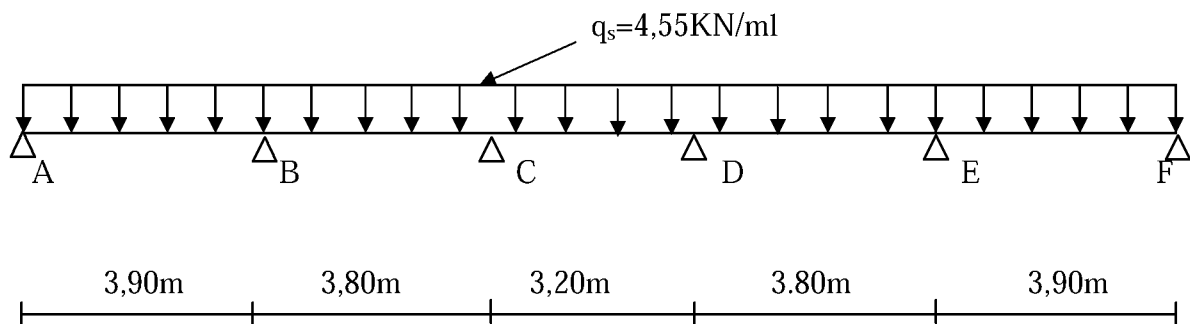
Schéma statique de la poutrelle à l'ELS.
